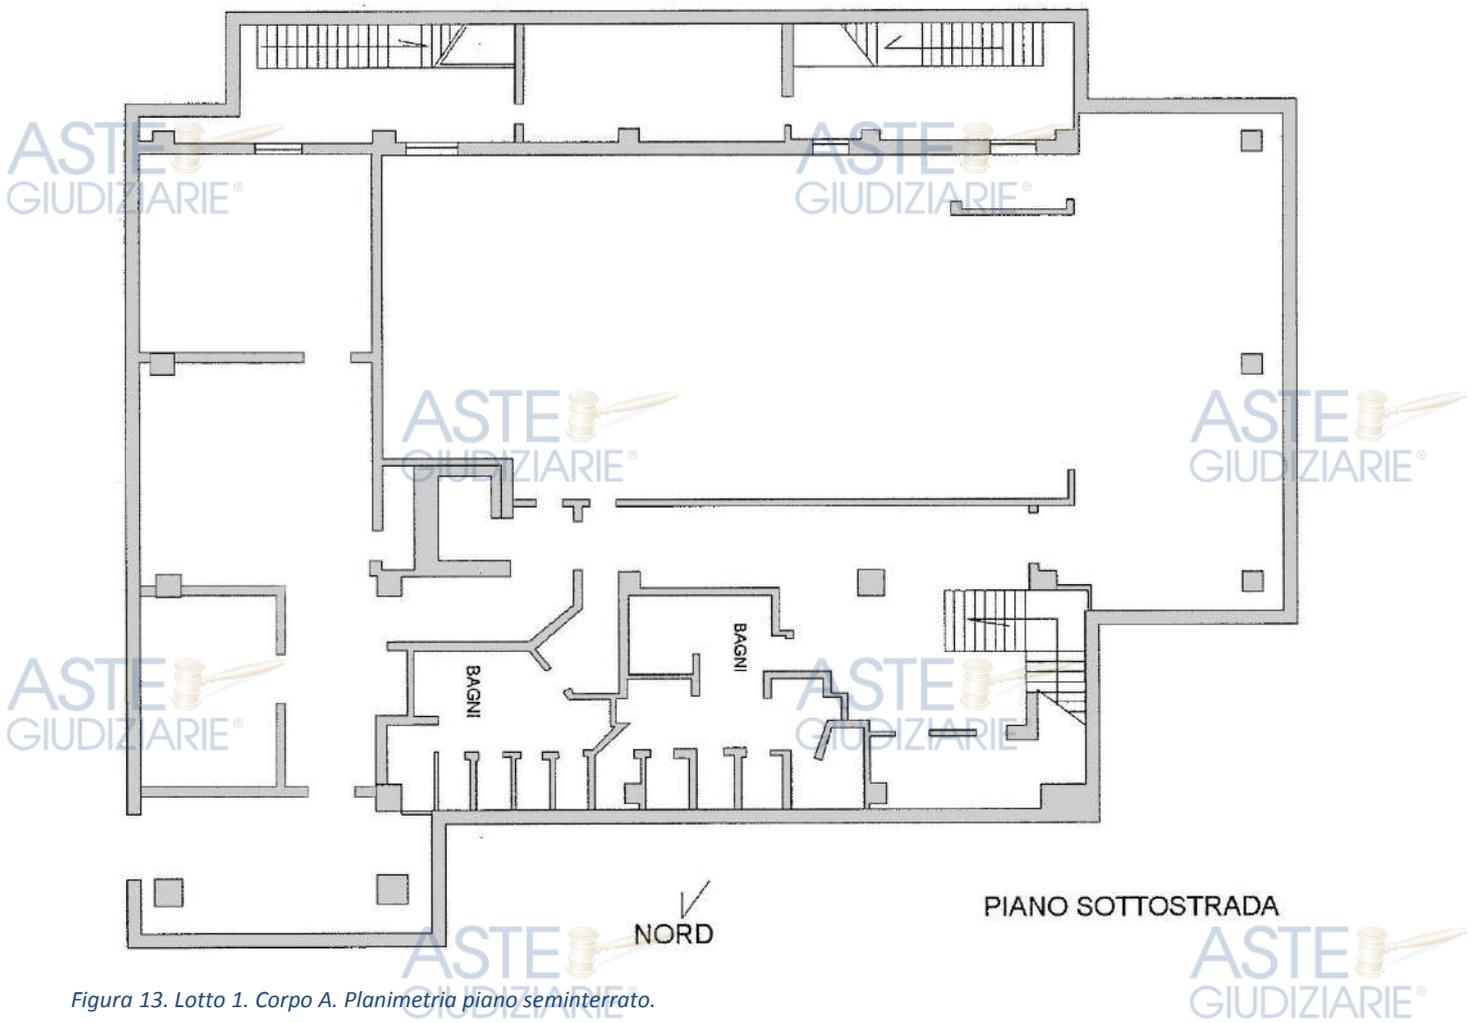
Lotto 1. Corpo A. Planimetria piano seminterrato.
